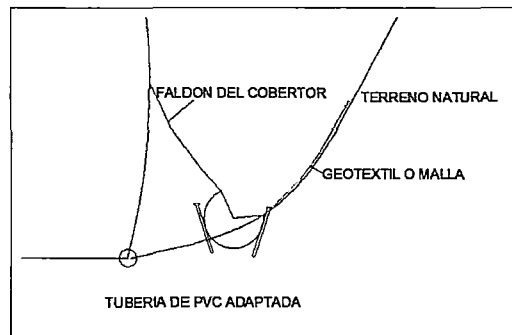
Propuesta 2 para el Drenaje Longitudinal
